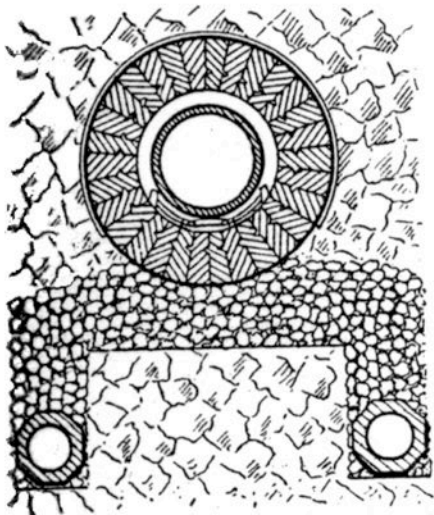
Dispositif des conduits souterrains et de leur revêtement (American District Steam C. Y.).
